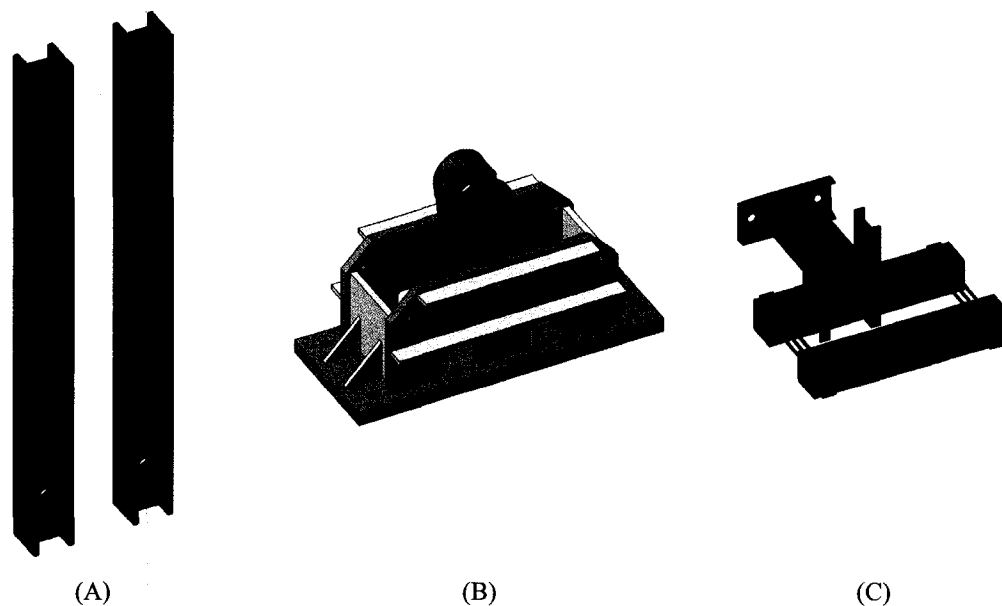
Poteaux, rotule et retenue latérale des poteaux du cadre d'essai
